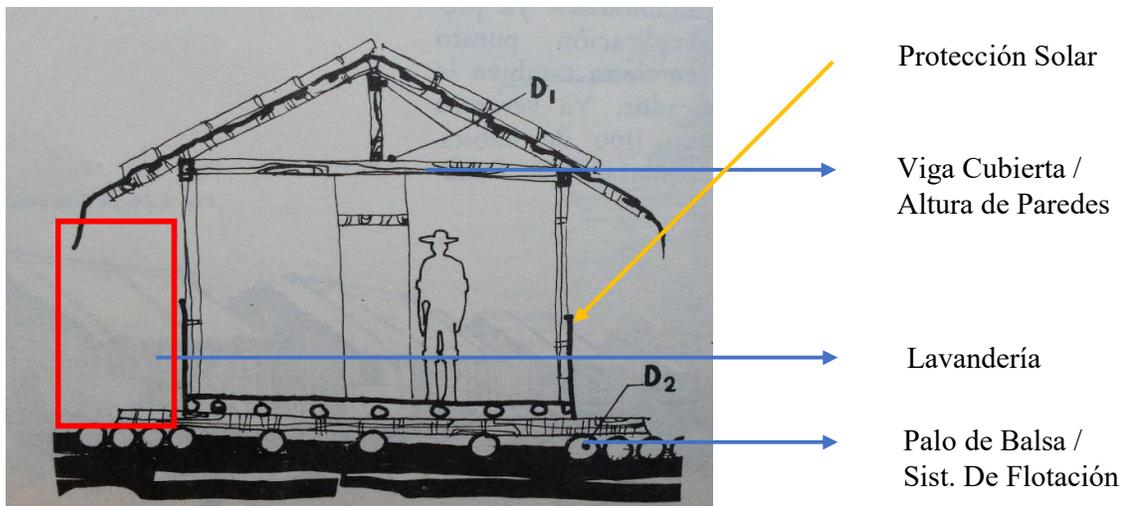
Corte Transversal Vivienda Flotante
